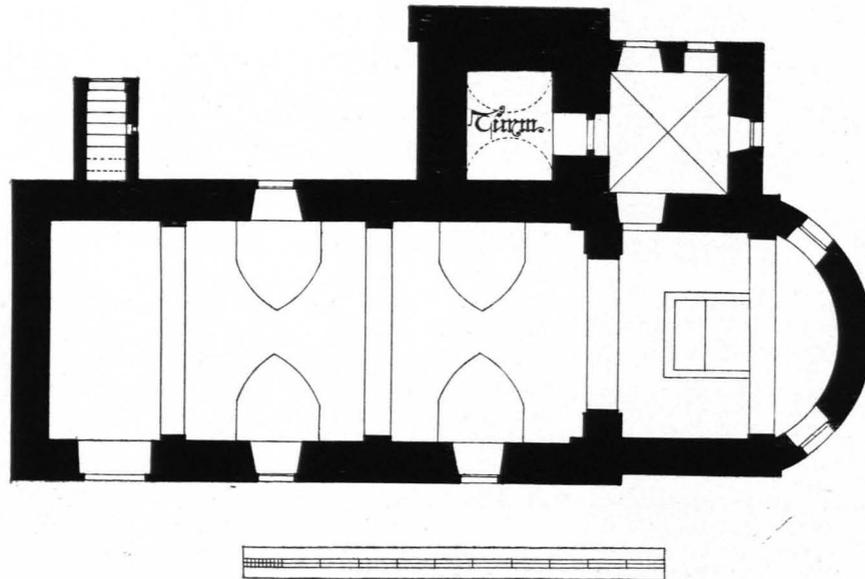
Nonndorf an der Wild, Pfarrkirche, Grundriß 1:200 (S. 440)
